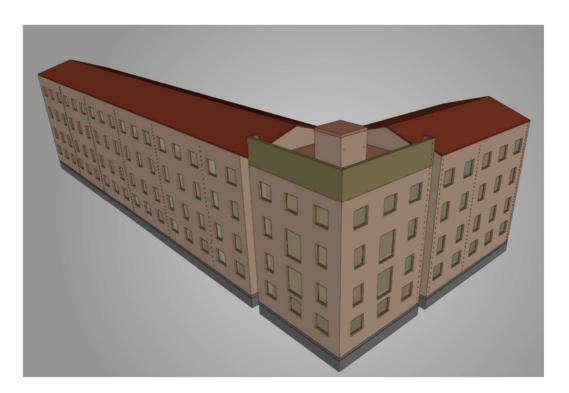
Vista 3D del edificio. Orientación noroeste.32
